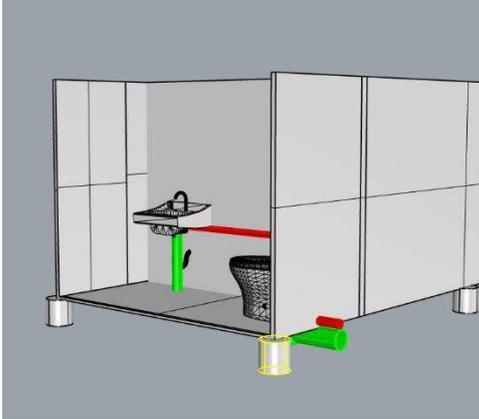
Esquema de instalação hidráulica vista 2 (Fonte: Autor 2021)
